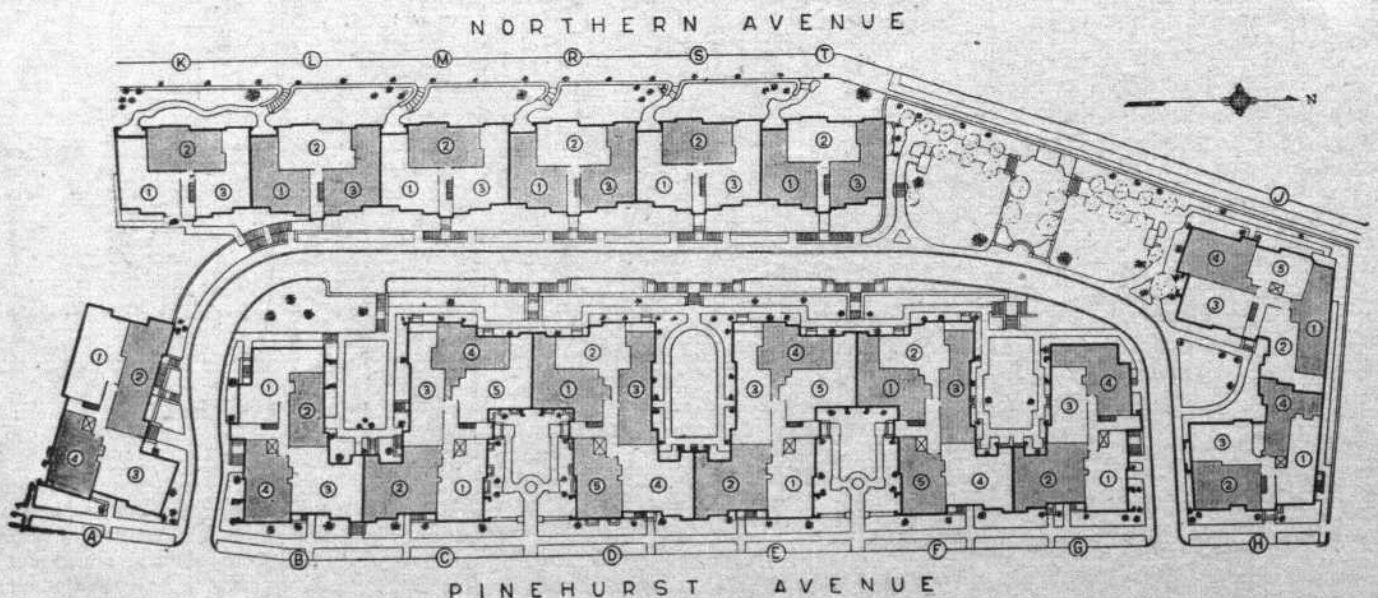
Lageplan der Hudson View Gardens, New York. Maßstab 1:1300
